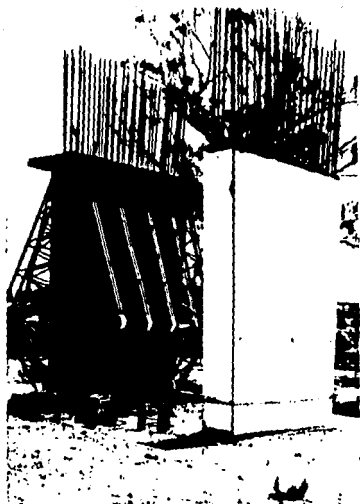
CIMBRA EN LAS COLUMNAS.
